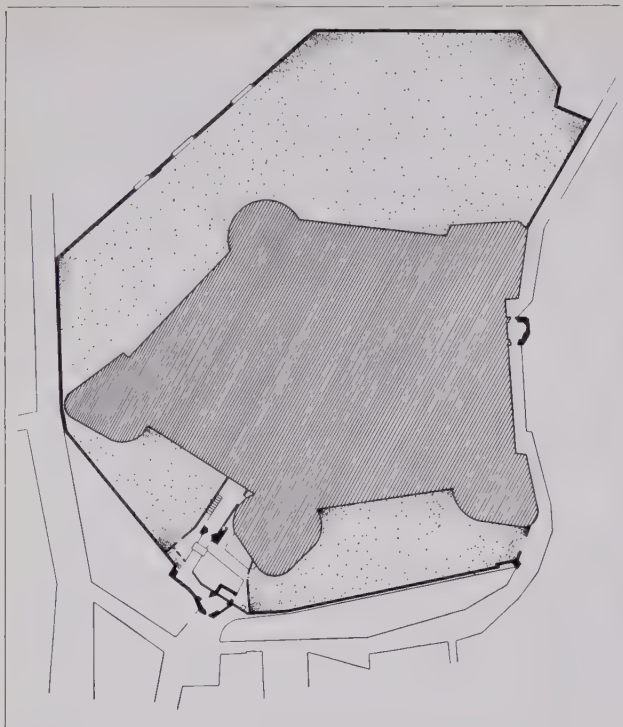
Fortezza di Civita Castellana, planimetria generale schematica
